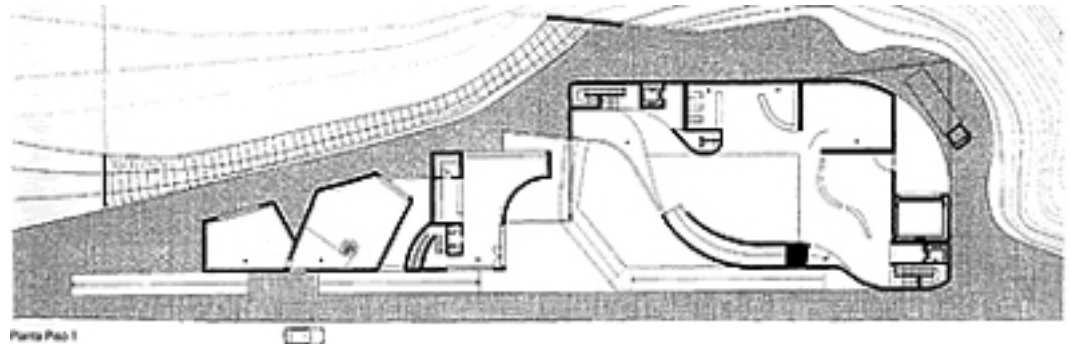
Planta baixa do 1º pavimento do Museu Iberê Camargo.
